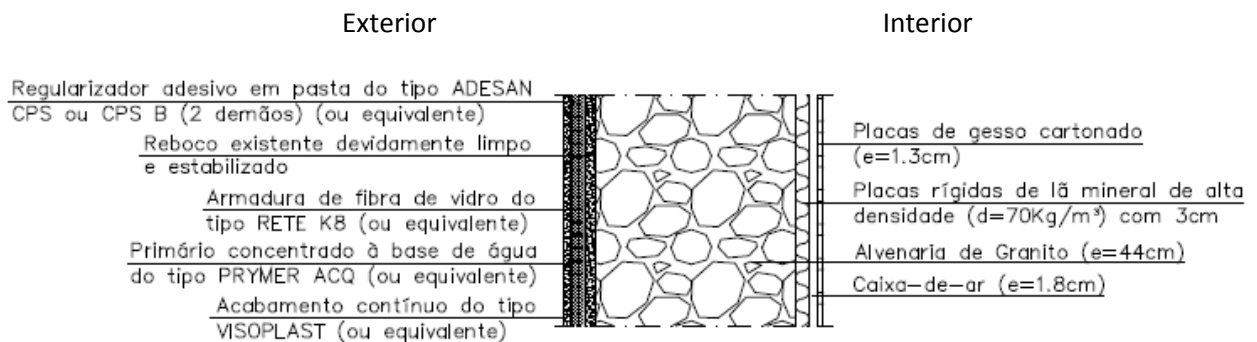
Pormenor construtivo da parede Pe1 [19]
